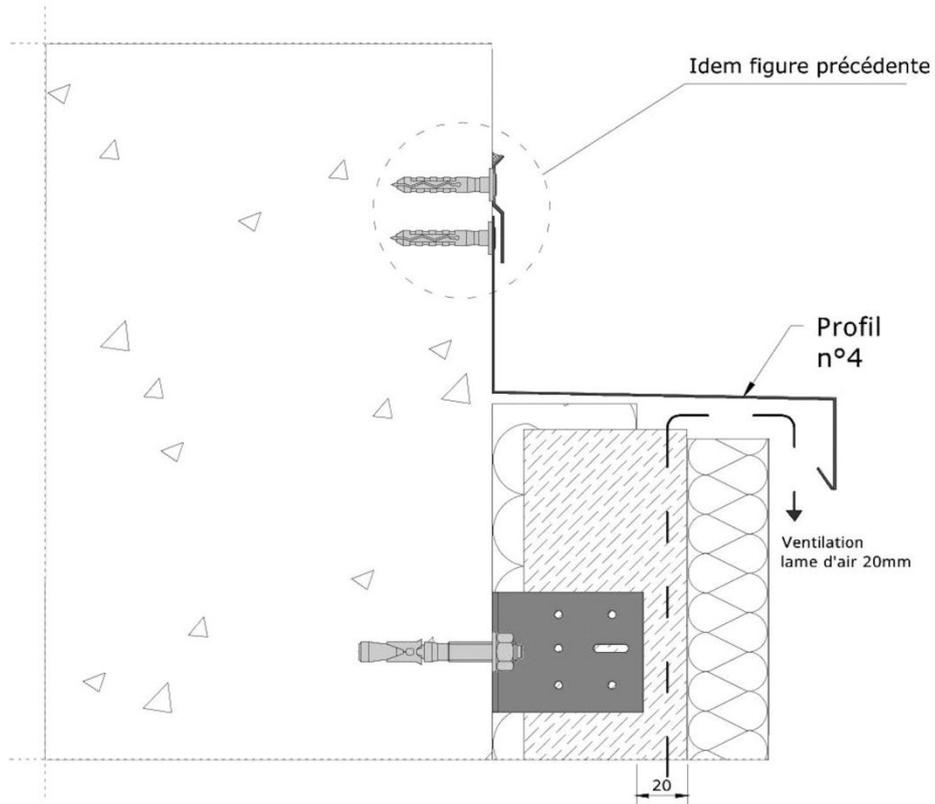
2 - Bas de façade – Pose en bardage rapporté double réseau, lames verticales (coupe verticale)
